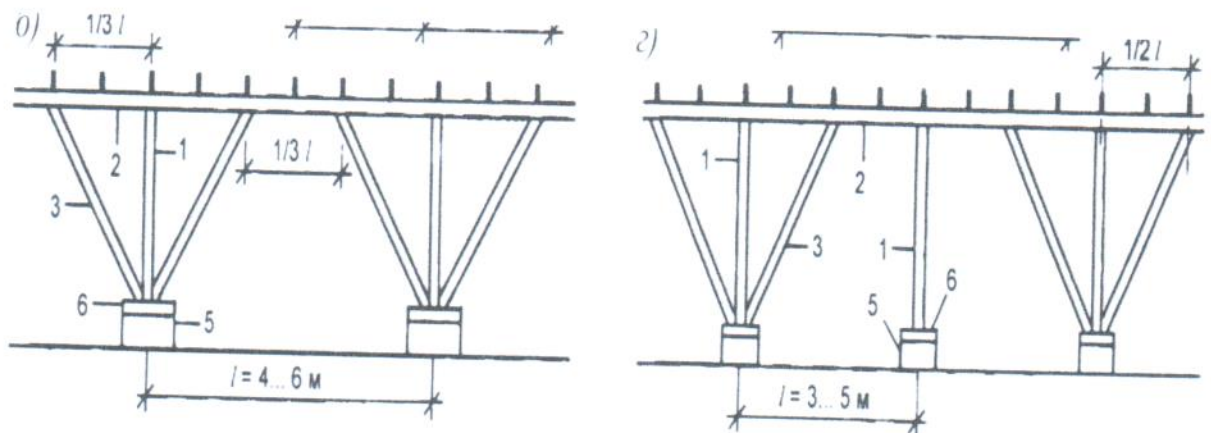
Схемы деревянных продольных стропильных рам и их элементы:
